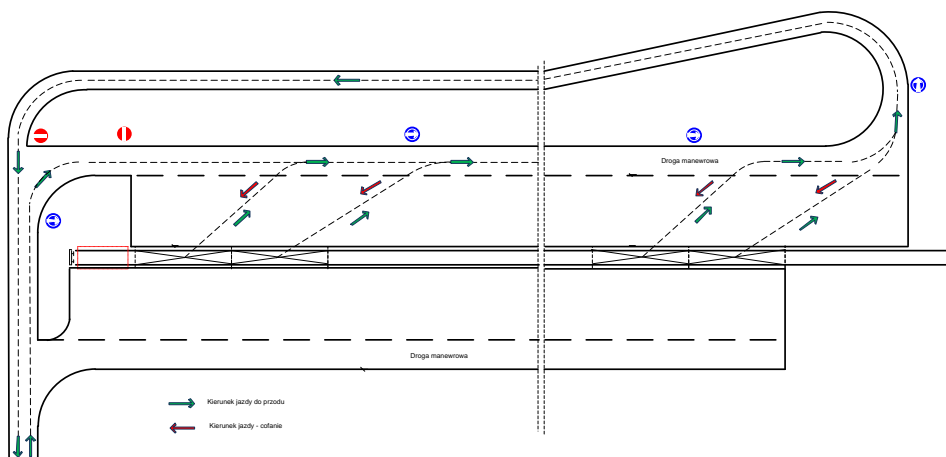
Przypadek „a” – organizacja ruchu – rozładunek
